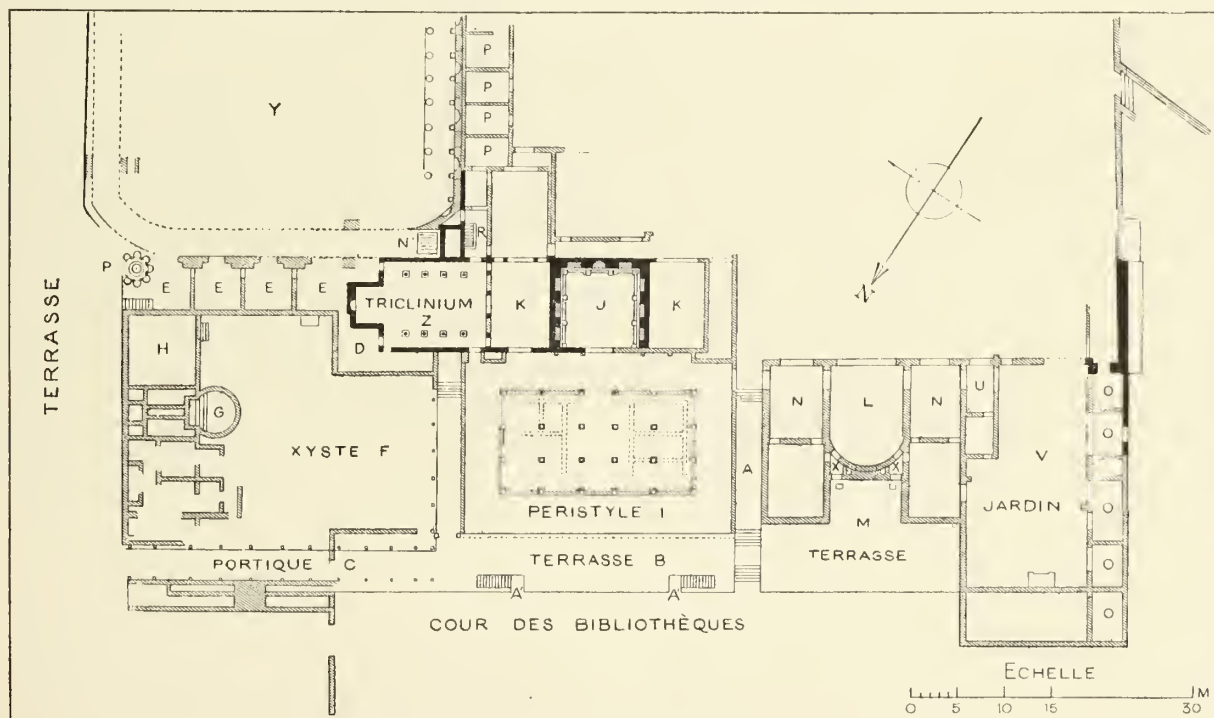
PLAN DU GROUPE CENTRAL DES CONSTRUCTIONS DE LA RÉGION NORD-EST (D'APRÈS WINNEFELD).
